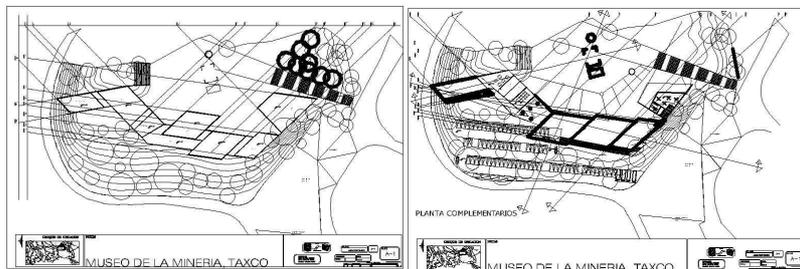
Y 45. Planos de Trabajo Arquitectónicos
